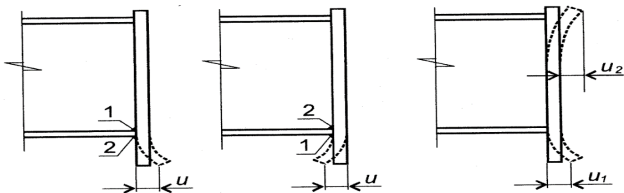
Основные виды возможных нарушений стыков (узлов) соединений стальных конструктивных элементов от сварки [3] 1, 2 – очередность процессов устройства сварных швов; u_1, u_2, u – схематическое представление остаточных сварных деформаций (грибовидности) фланца.
